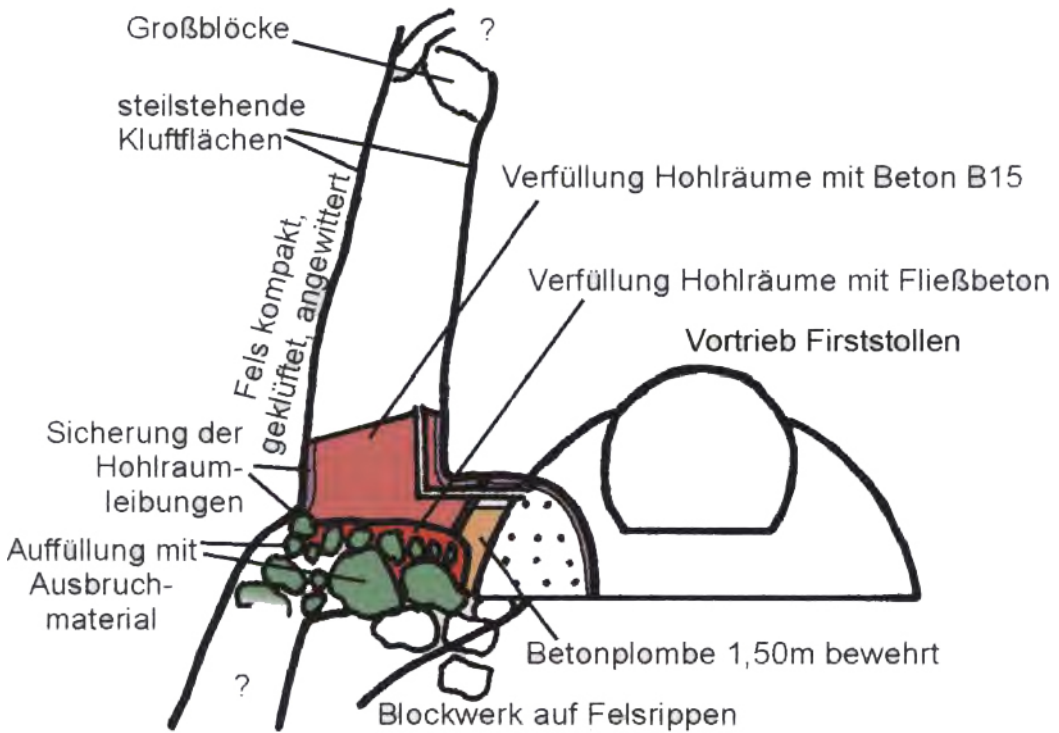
Skizze einer Hohlraumverfüllung im Tunnel Irlahüll nach JOHN & STRAPPLER (2003)
